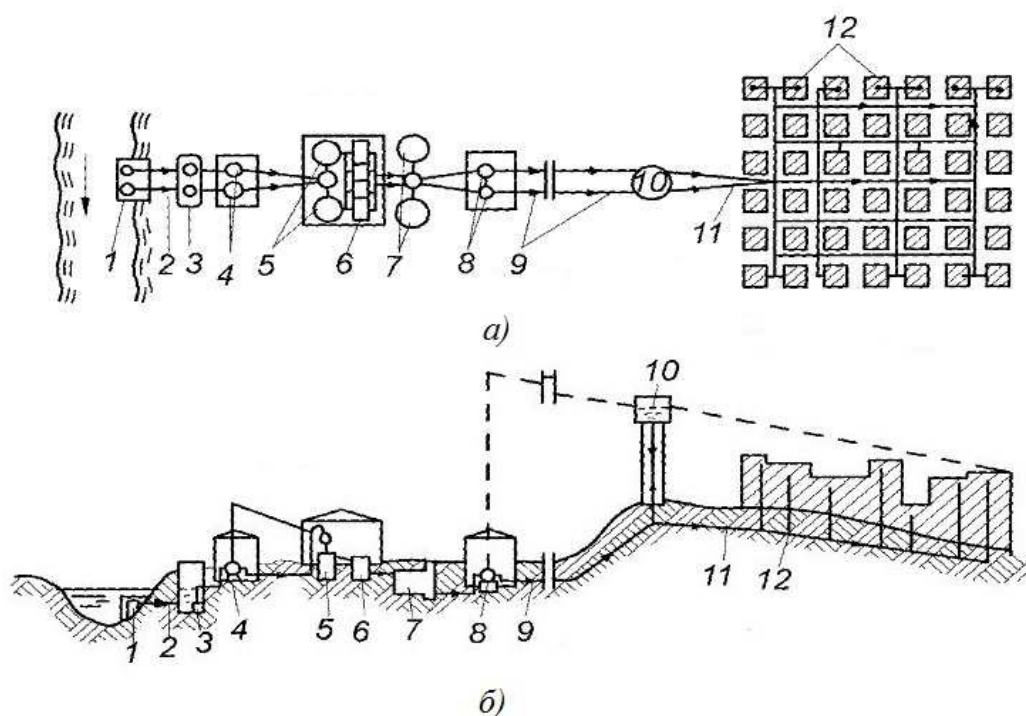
Схема водопроводу міста; а) — план; б) — розріз
